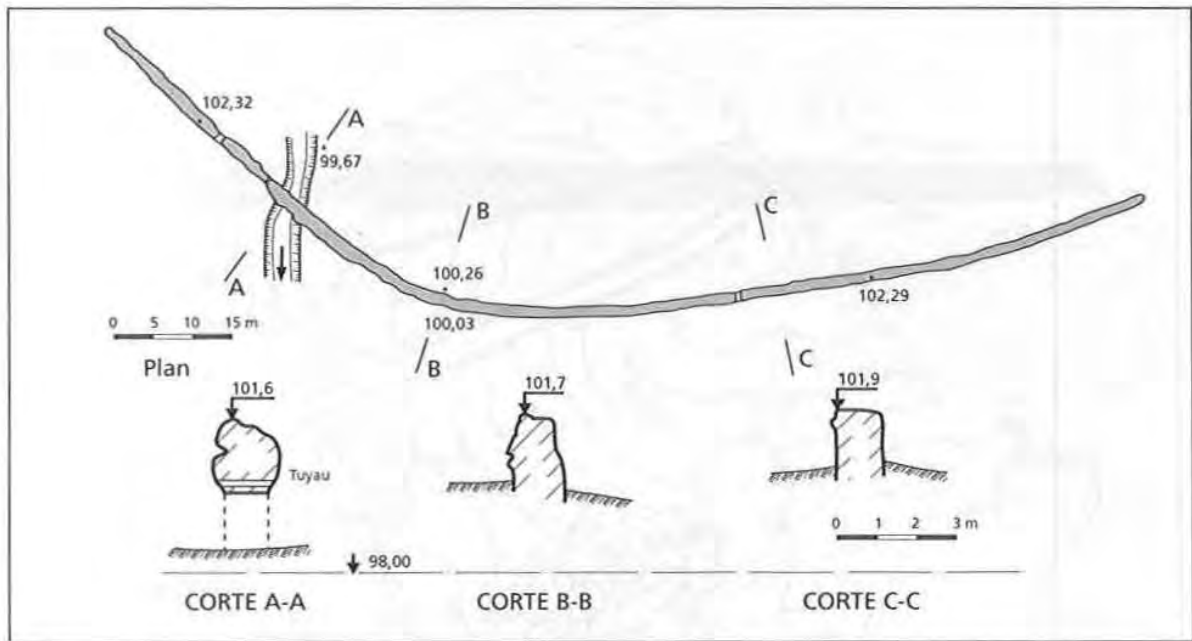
Barrage de Muro dos Mouros (Serpa). Plan et coupes.
